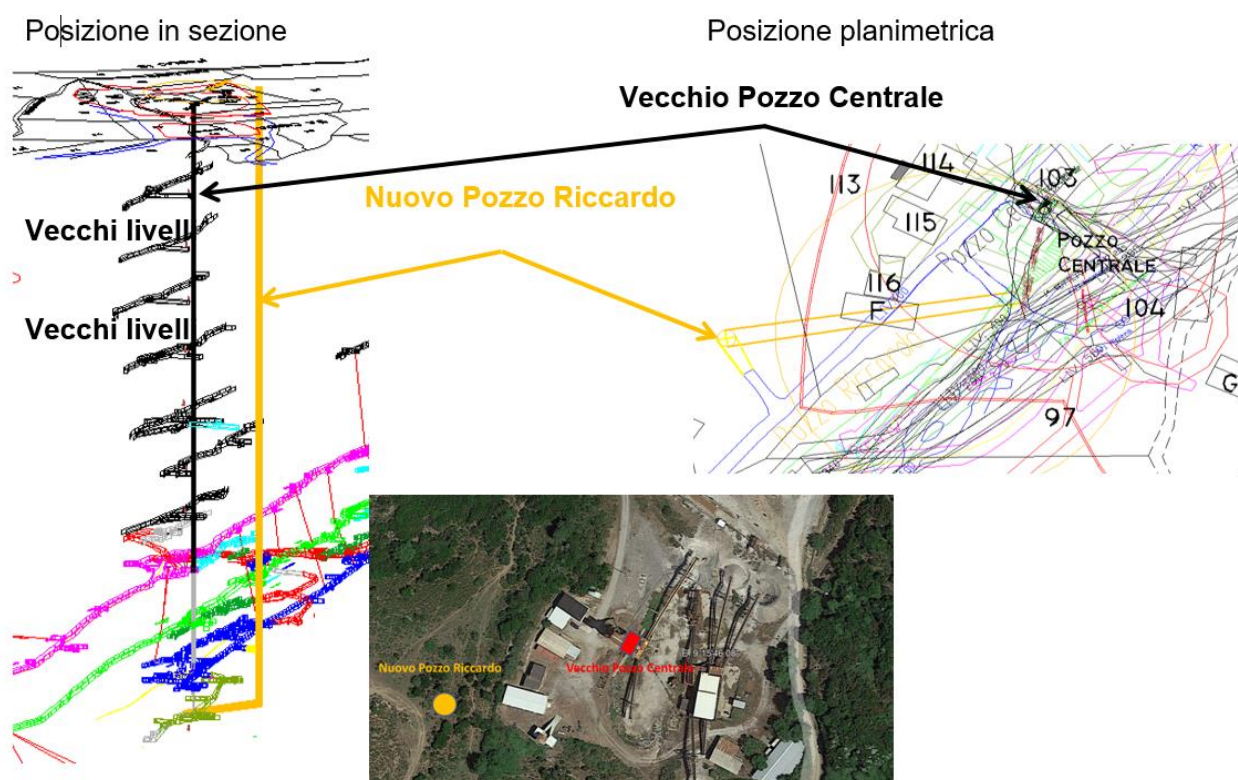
Posizione del pozzo esistente (quadrato rosso nell'ortofoto qui sopra, colore nero nella sezione e planimetria) e del nuovo pozzo Riccardo (colore giallo).
